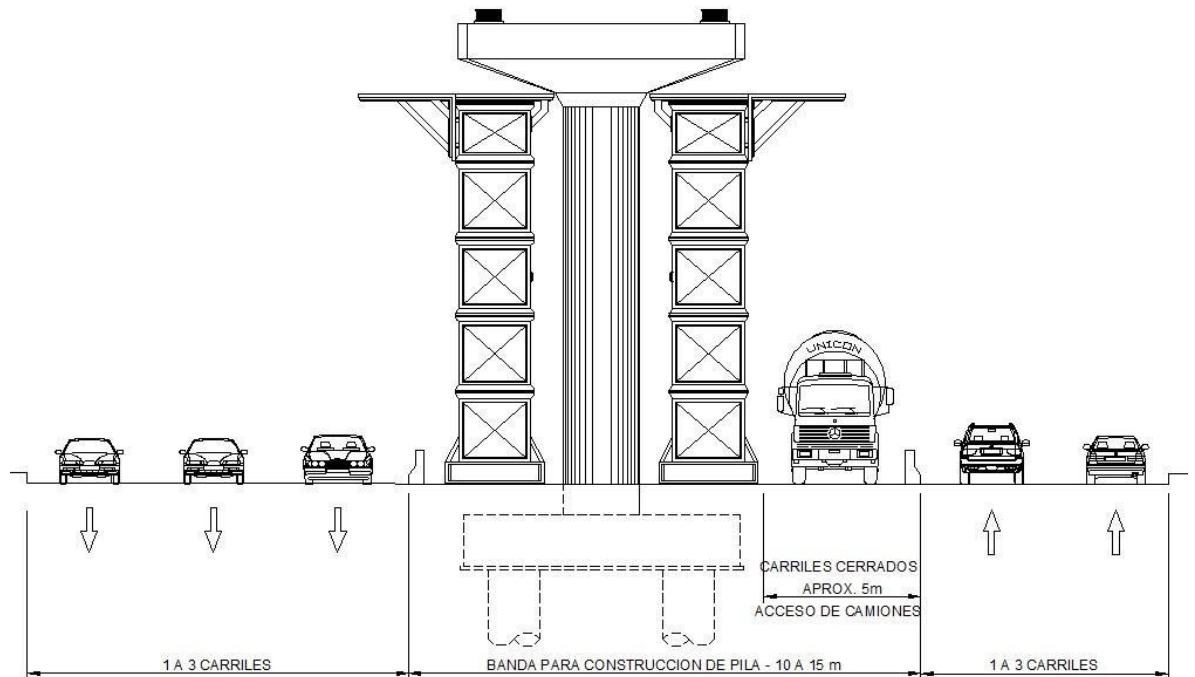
Zona de trabajo necesaria para ejecución de pilas
